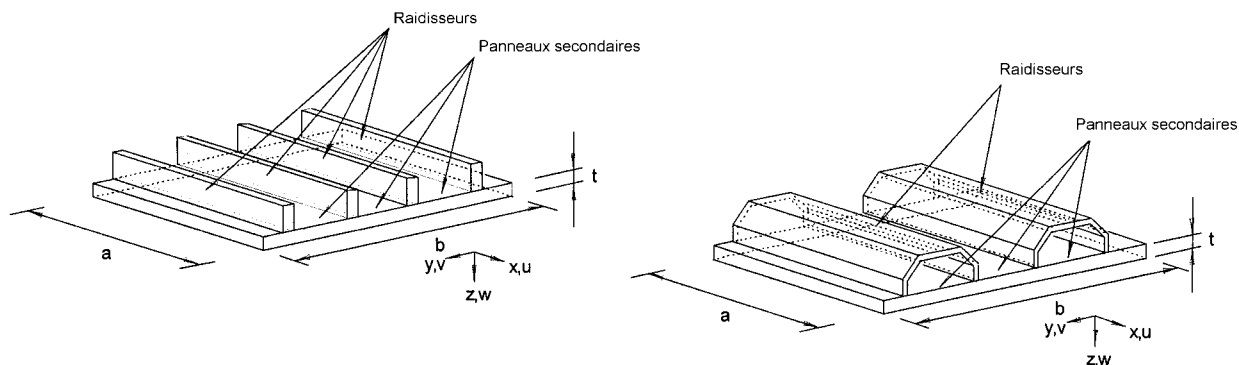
Dimensions et axes de segments de plaque raidis ;
